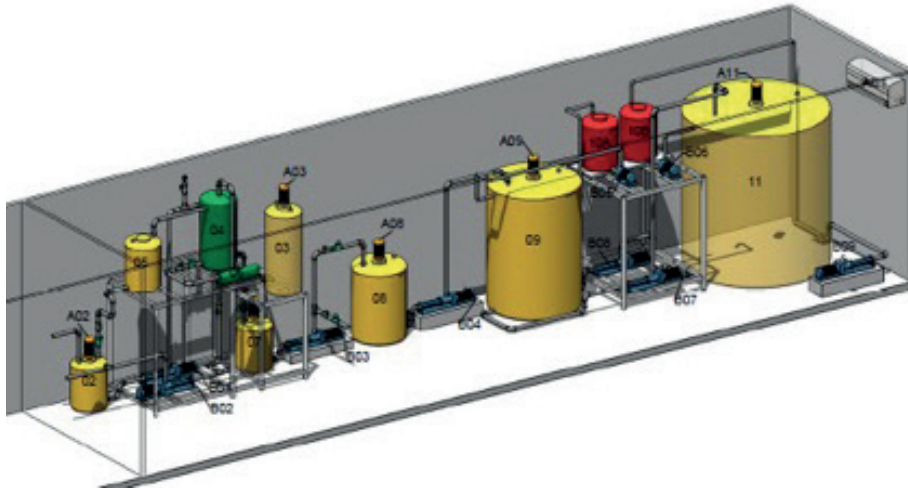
Diseño y ejecución de la planta piloto preindustrial
